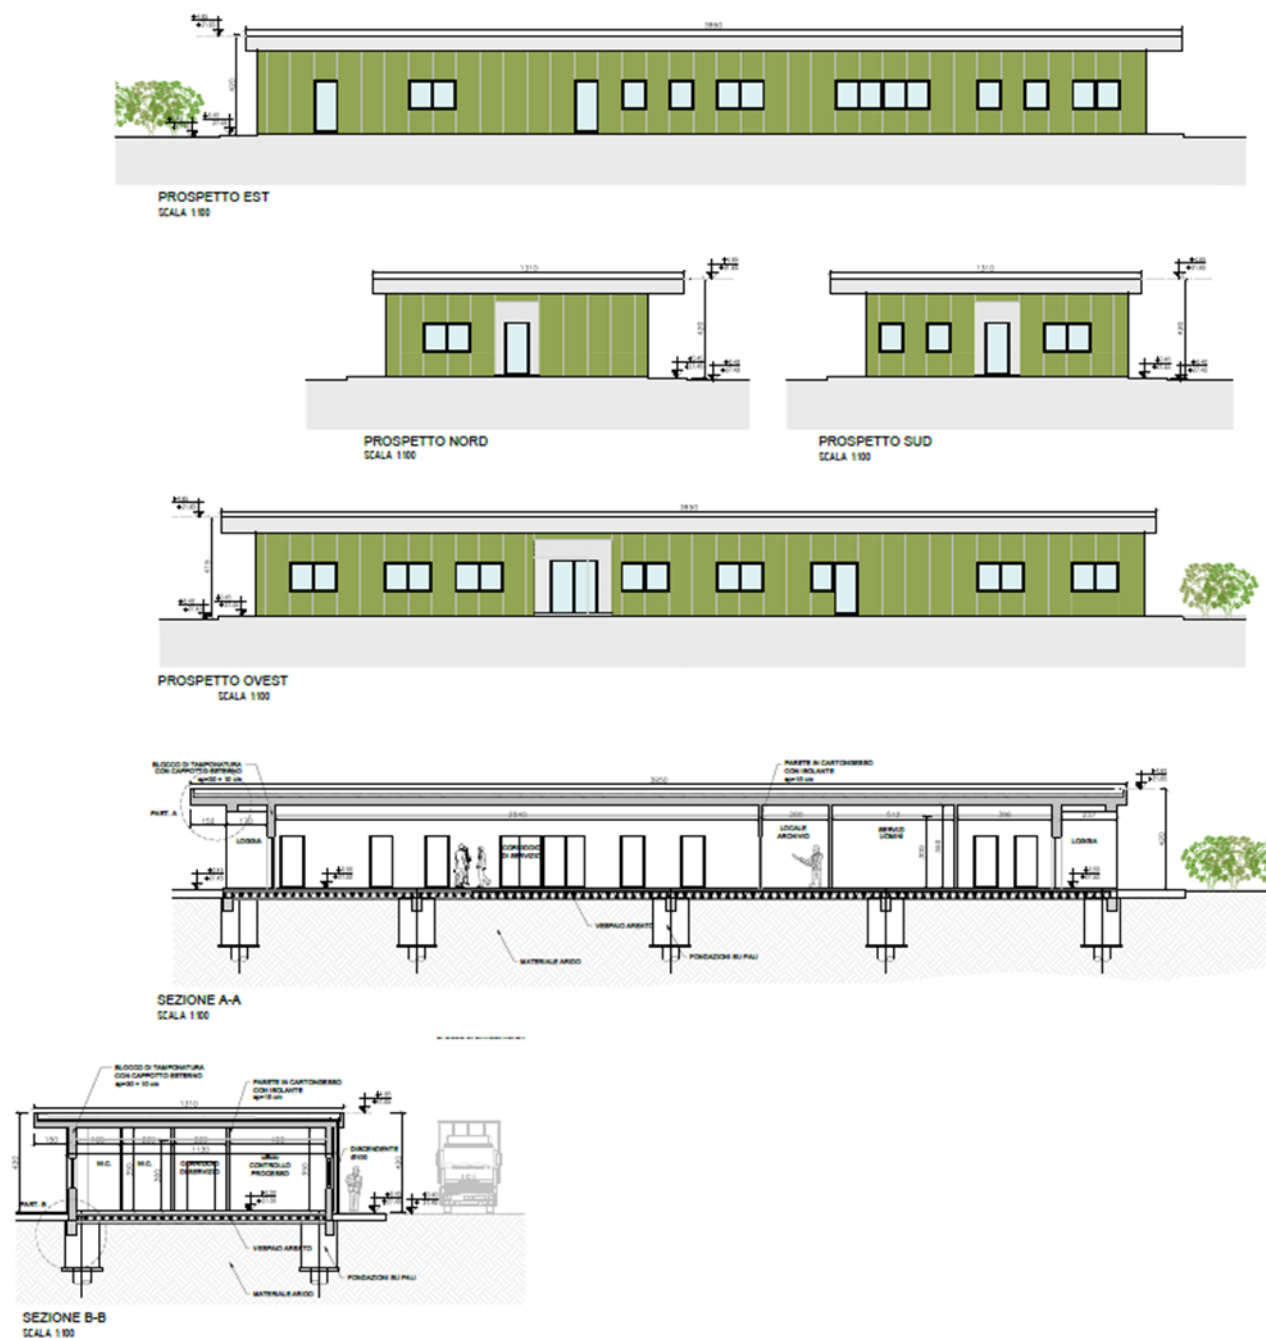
Prospetti e sezioni edificio uffici/servizi addetti
